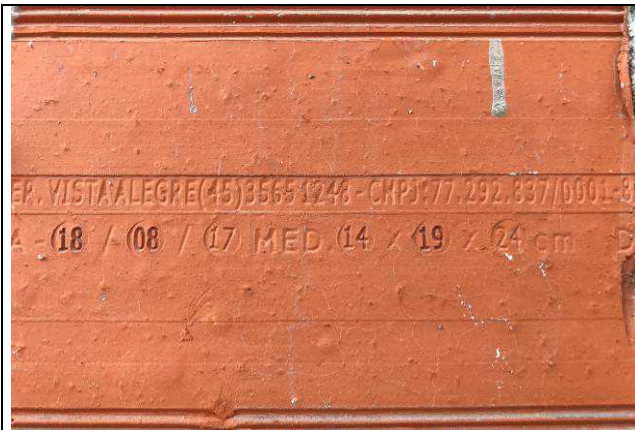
C: Tijolo utilizado para as paredes de fechamento do arquivo.
